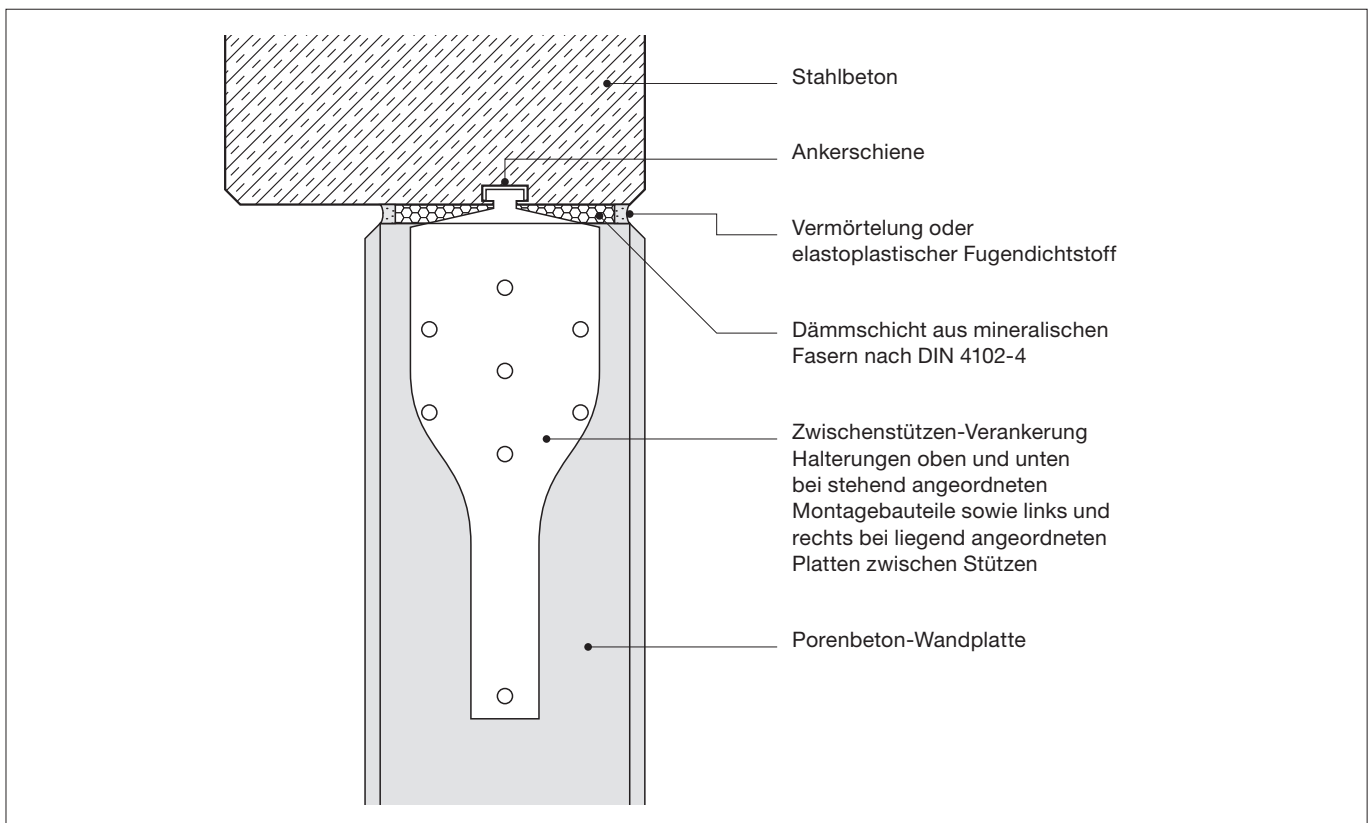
Nachgewiesener, standsicherer Plattenanschluss bei Brandwänden (Anschluss Wand-Wand, Wand-Stütze oder Wand-Decke) bis zur Klasse F 90-A
